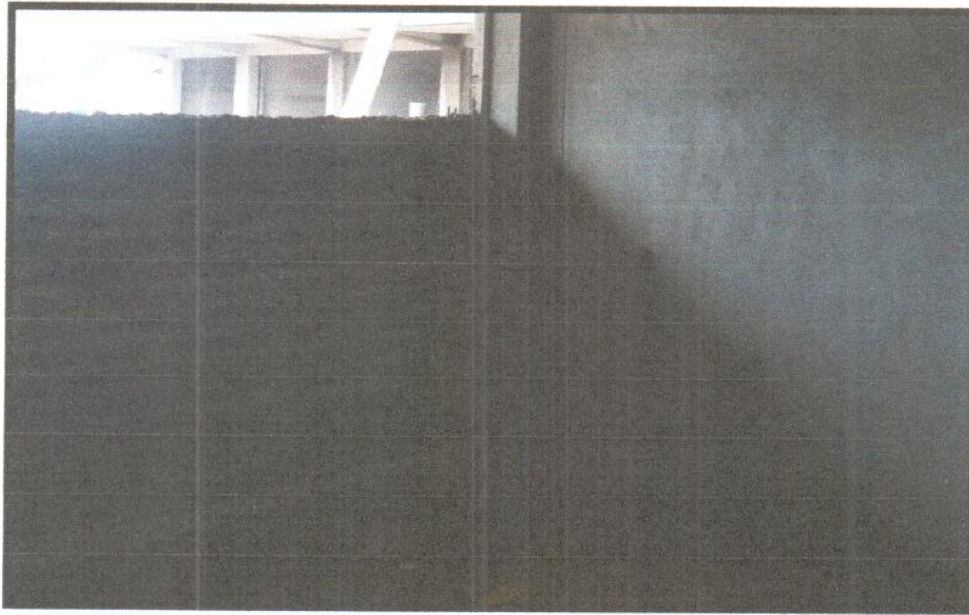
CONCRETO, ENCOFRADO Y DEENCOFRADO COLUMNETAS. MODULO 003
